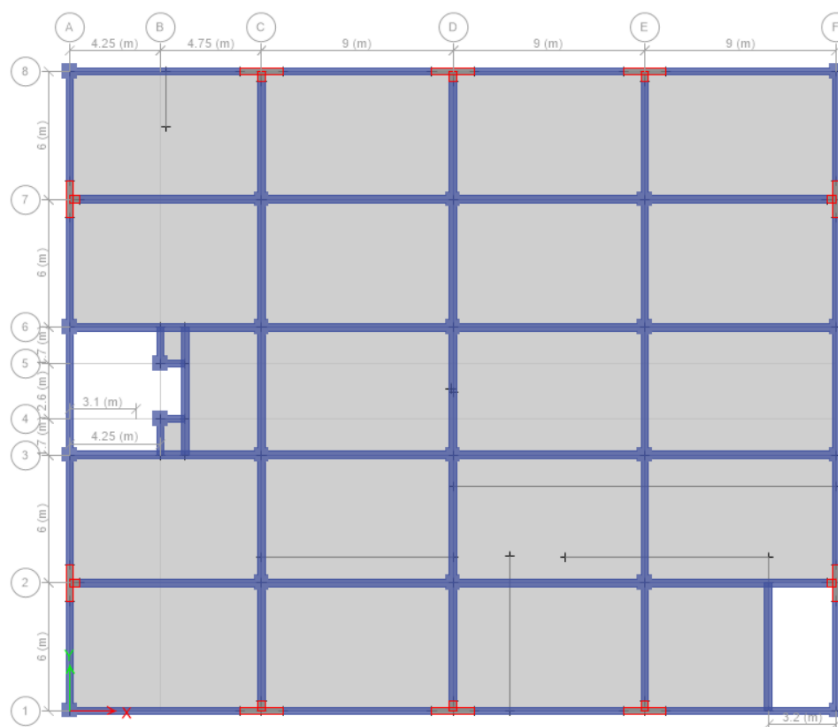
Vista en planta de la estructura. (Fuente Propia).
